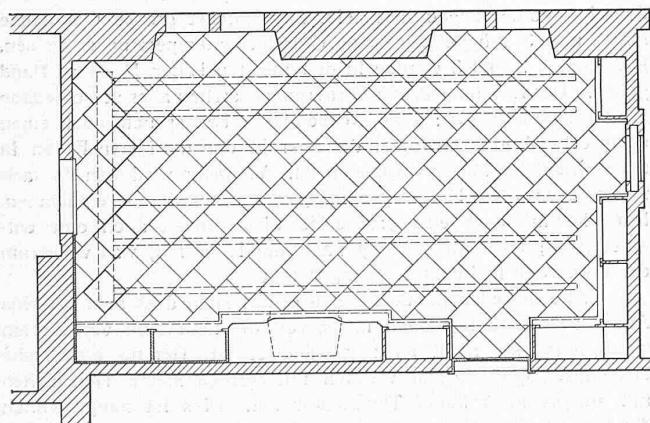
Grundriss eines Zimmers mit Angabe der Heizrohre im Fußboden.
